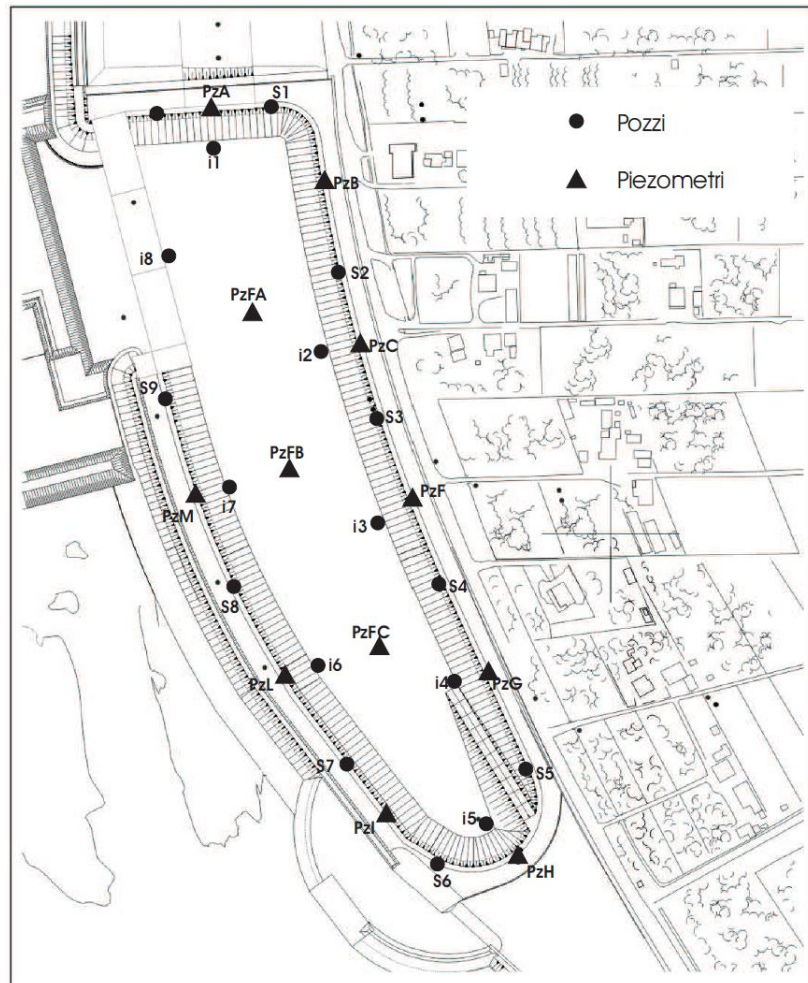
Planimetria del sistema di dewatering della tura (fonte: Consorzio Venezia Nuova).
